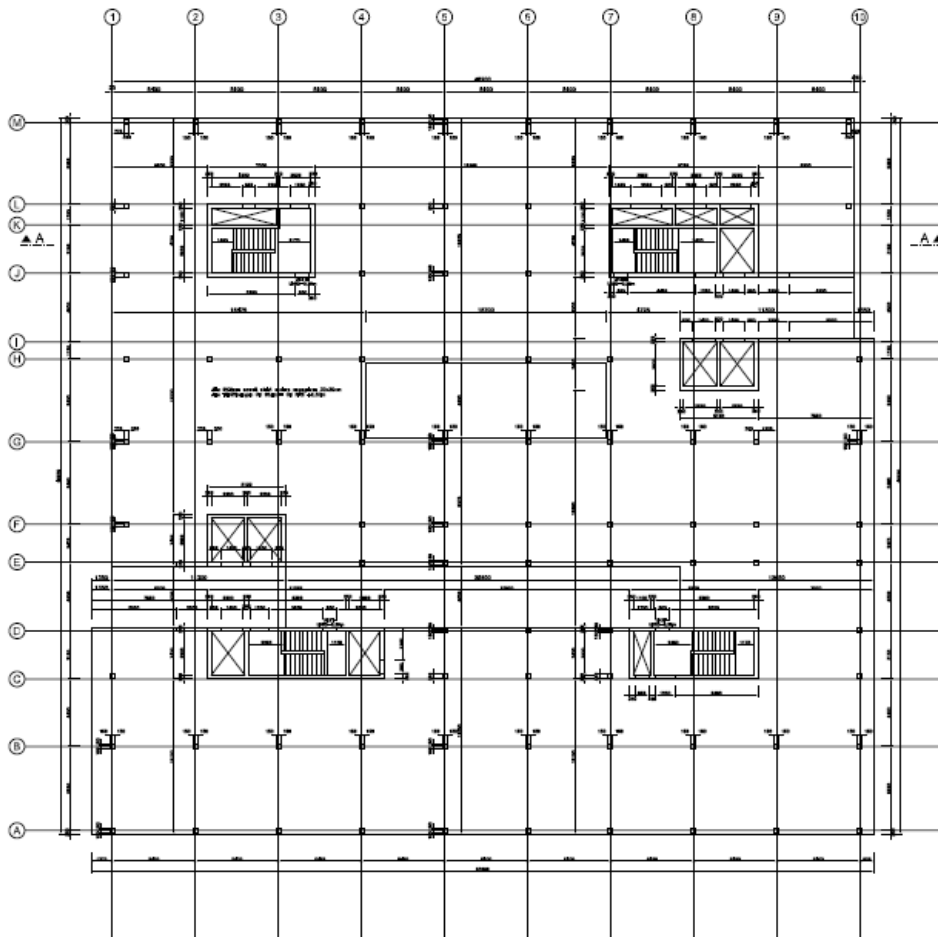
Grundriss – Regelgeschoss (Doka [1])
